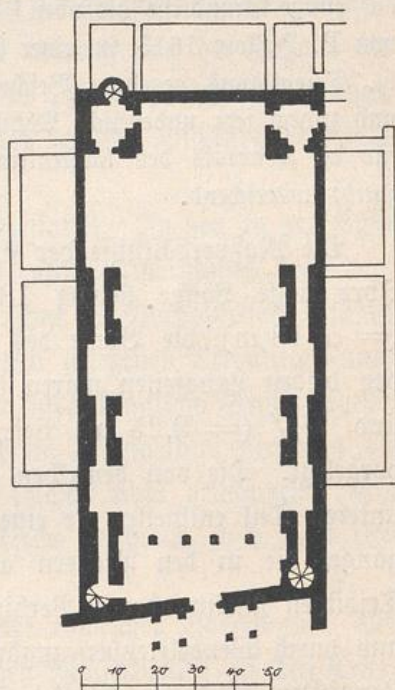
Douai. Jesuitenkirche. Grundriß und Erweiterungsplan.
